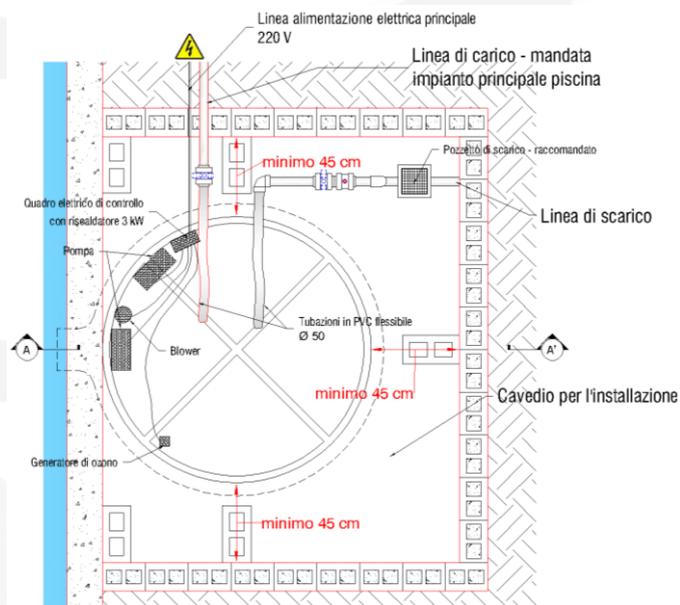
Installazione in linea – cavedio tipo per installazione – cavedio circolare
